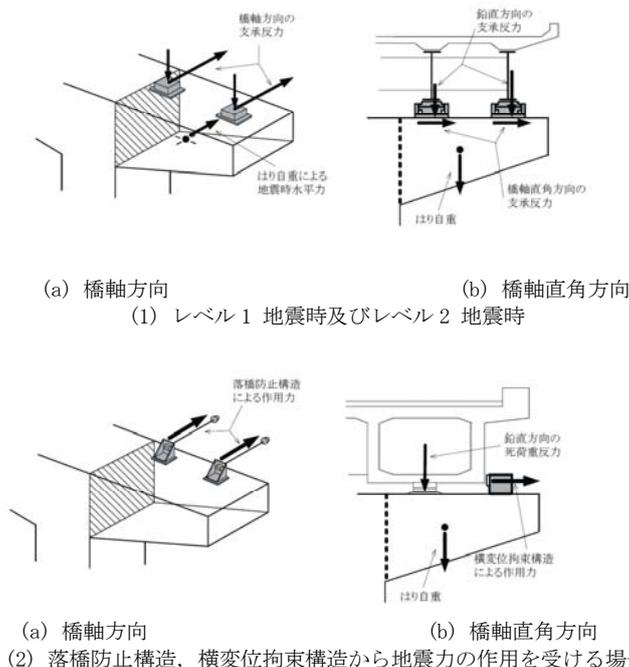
橋脚の張出ばりに作用する荷重の例 (道示IV編, 図-解 7.3.1)
